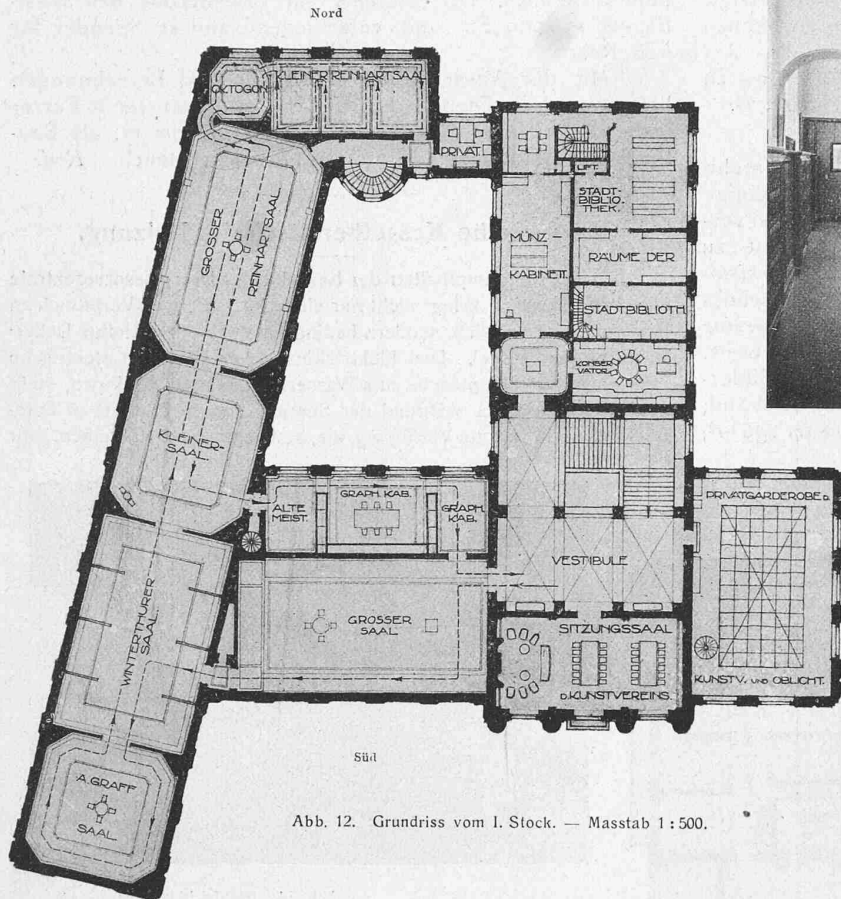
Grundriss vom I. Stock. — Masstab 1:500.
